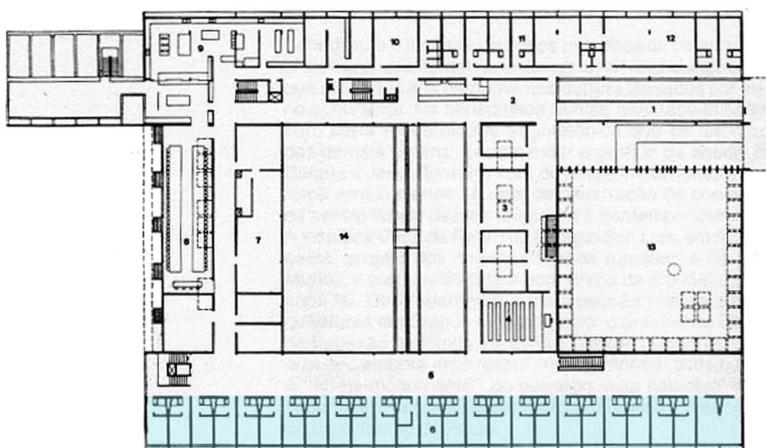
Celas do primeiro pavimento da Abadia de Santa Maria. (São Paulo, 1974-76) (Fonte: Revista Projeto n. 137, dez-1990 e jan-1991).
